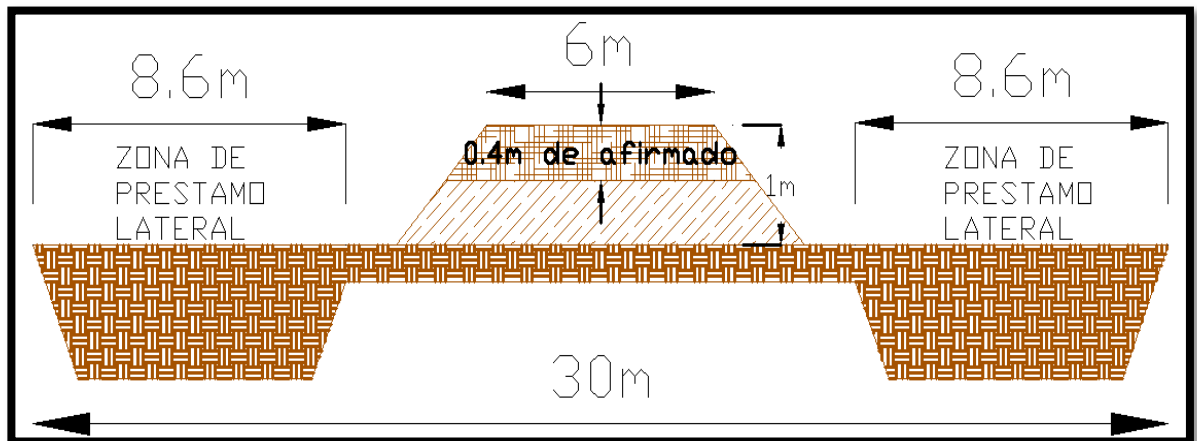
Diseño de planta de la vía de acceso a la locación Sulawesi 4
